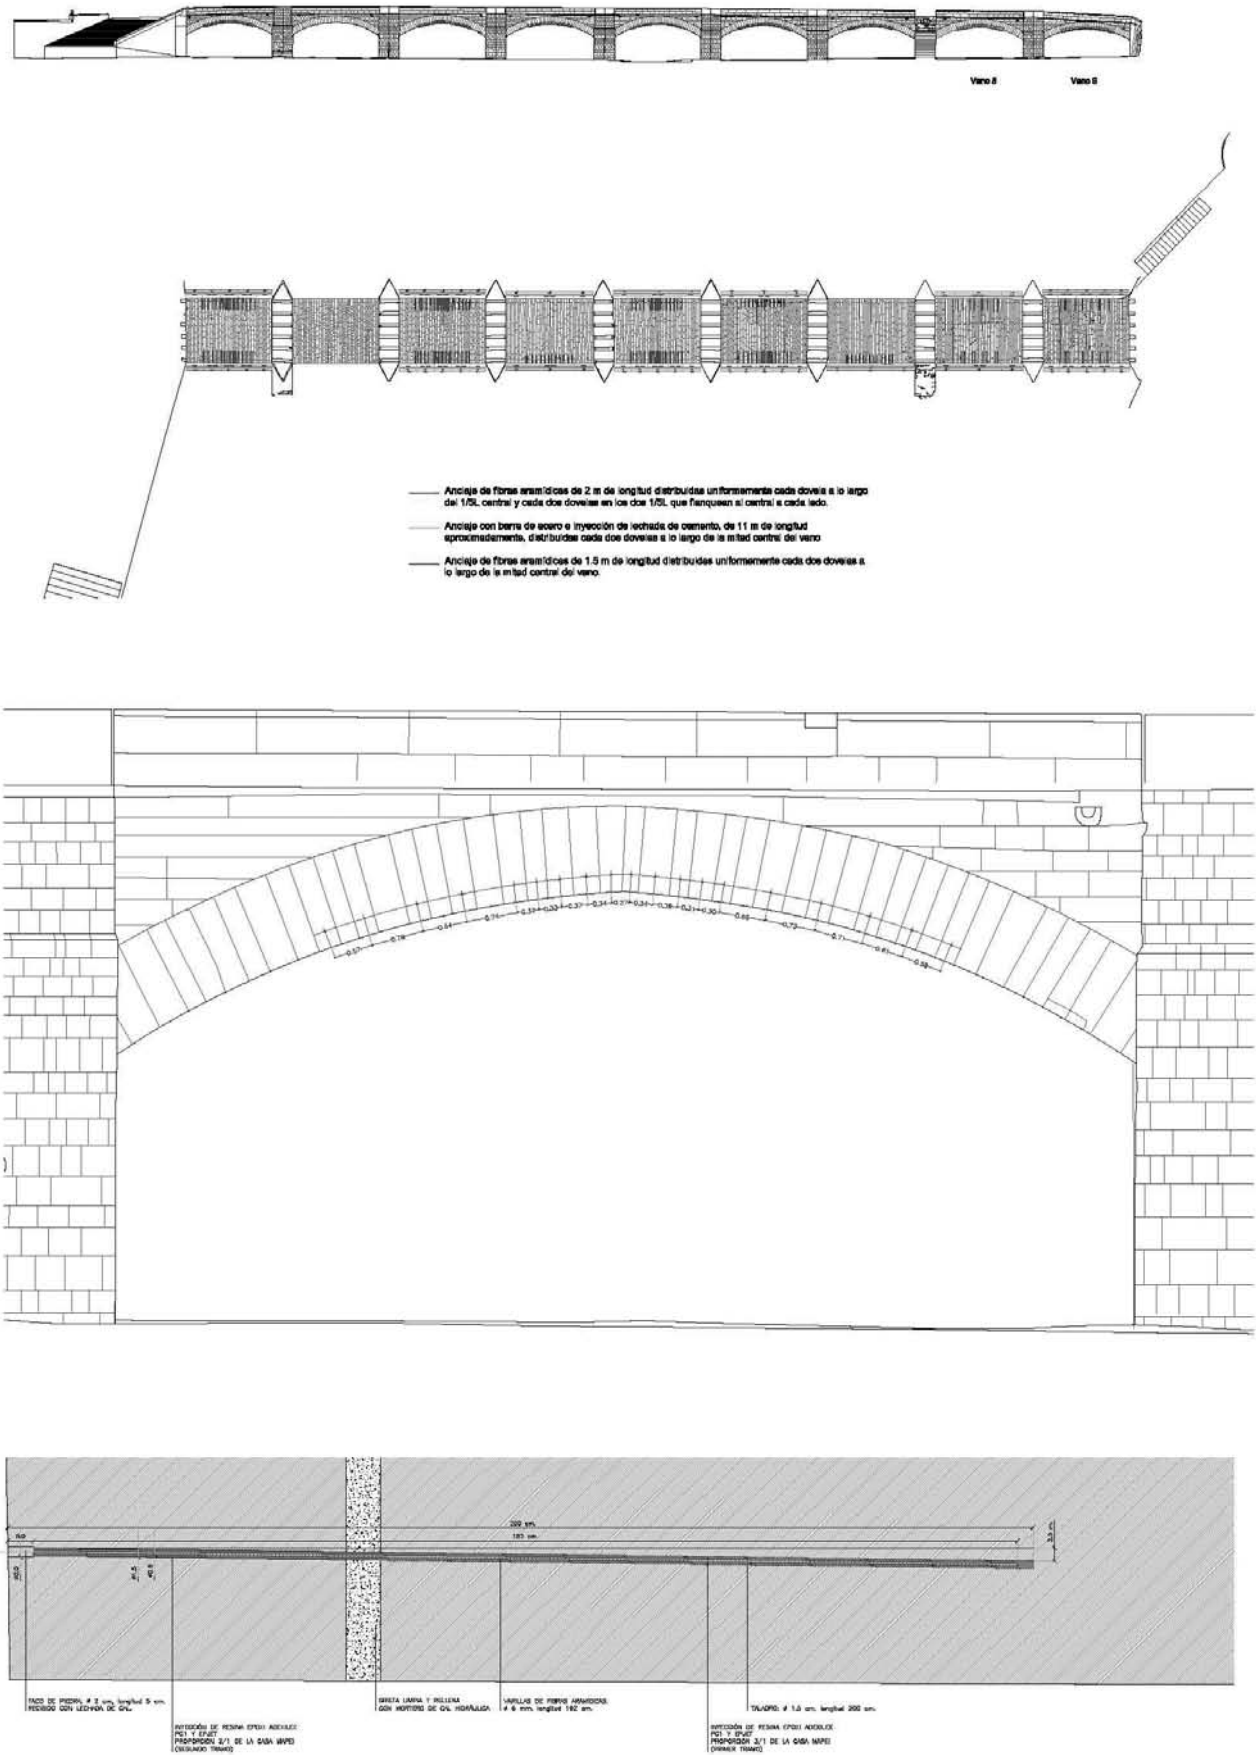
Planos del refuerzo-consolidación estructural del puente de Serranos.
